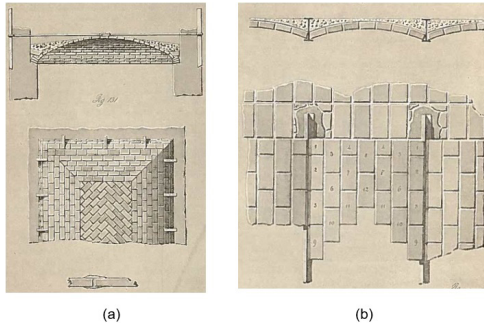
Emprego da abobadilha: (a) tradicional de barrete de clérigo: corte (em cima); planta (ao meio); pormenor de argamassamento da junta (em baixo); (b) entre perfis metálicos: corte (em cima); planta mostrando a sequência de execução por fiadas oblíquas (em baixo) (Formenti 1893)
